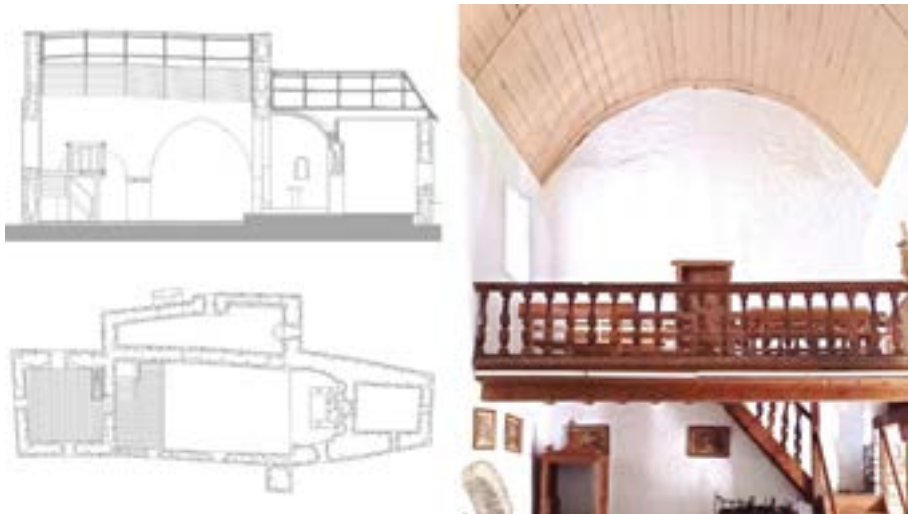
Planta e detalh dera seccion deth còr en balcon de Sant Tomàs de Casarilh [30]
